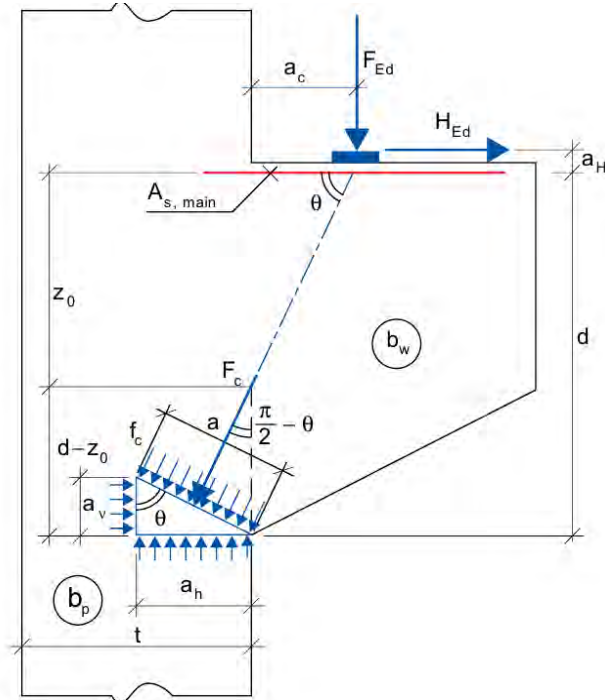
К определению угла наклона сжатого бетонного подкоса
